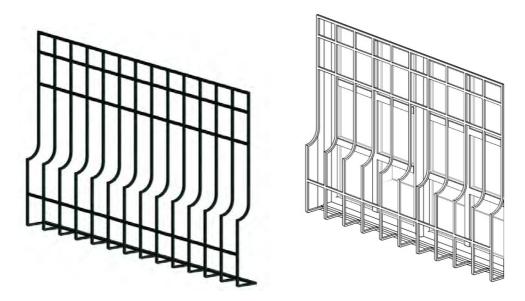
Stahlgitterkonstruktion der Fenster des 1. Untergeschosses an der Westfassade.
